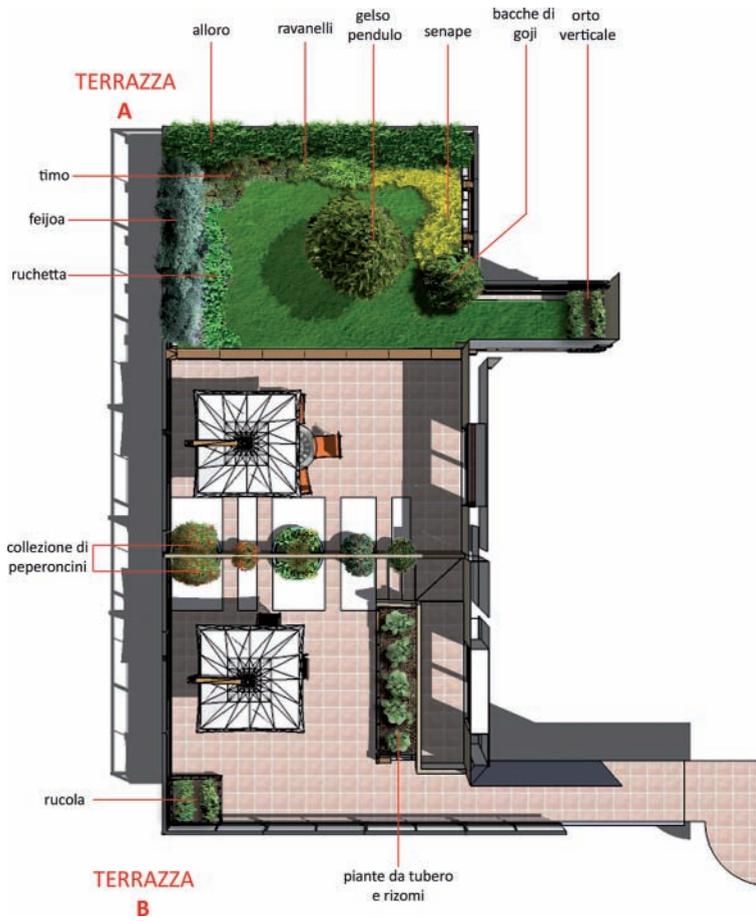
Planimetria (progetto paesaggistico Laboratorio di Architettura Ambientale di Catania)
